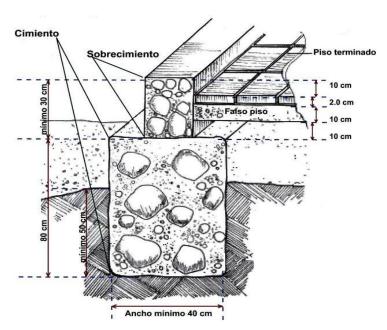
Detalle de Cimento de Piedra Fotografía de http://www.akyscrapercity.com.gt 2015
